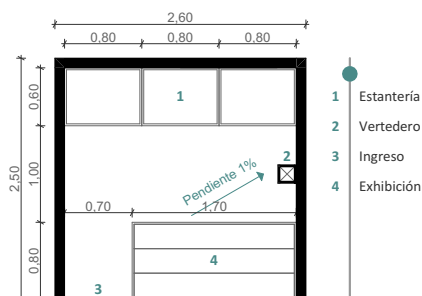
Planta de frutas, verduras. Fuente: Autores.
